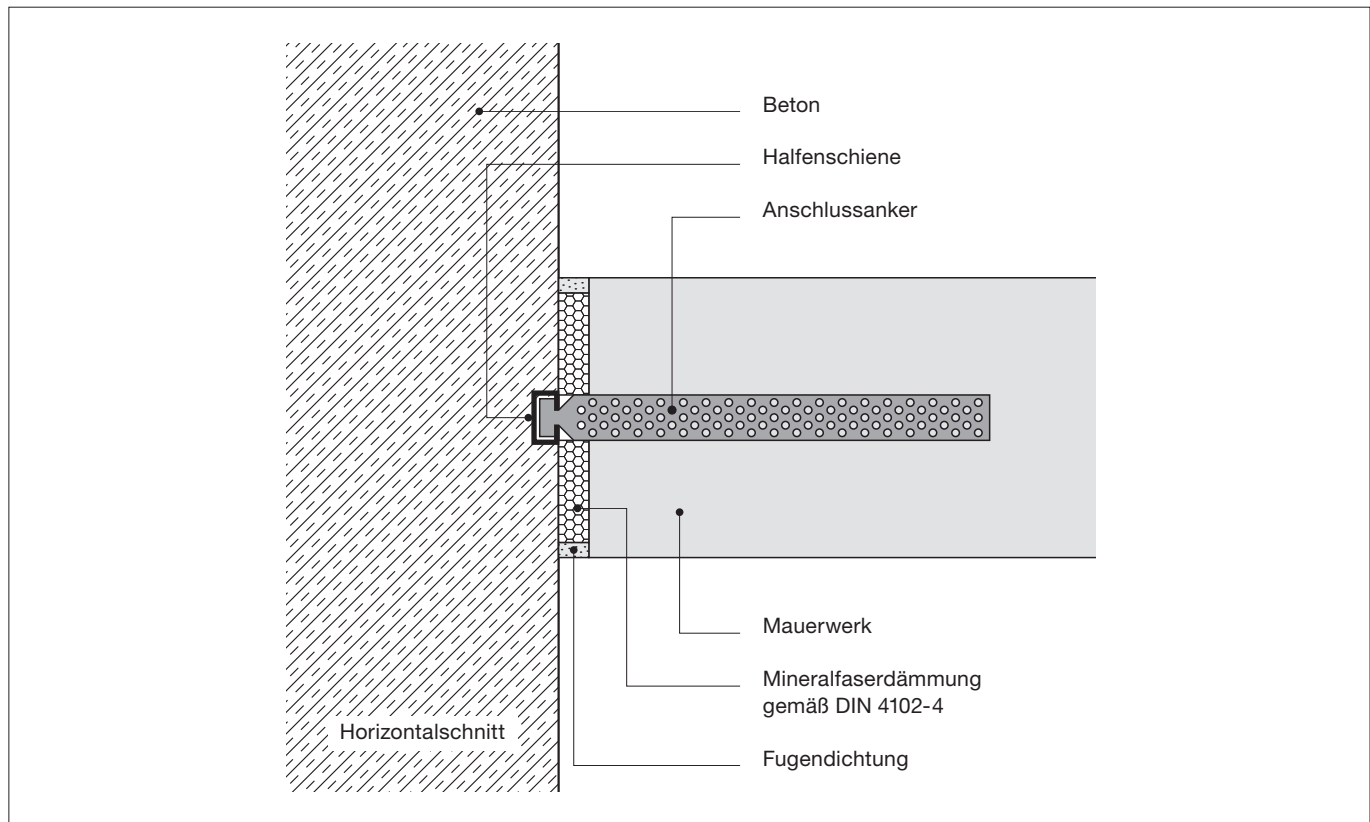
Gleitender Stoß Wand (Stütze)-Wand tragender Wände, Ausführung mit statisch erforderlichem Anschluss; zulässig auch für Brandwände
